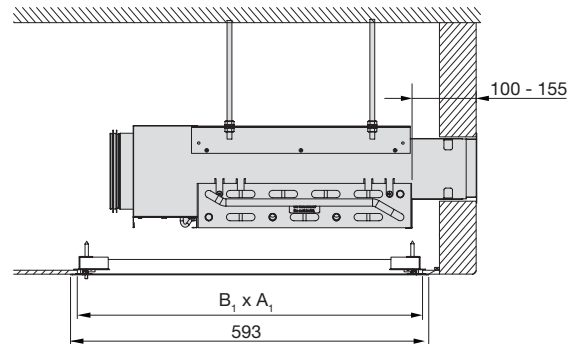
Montagezeichnung für Frontplatte -3S mit Ausschnittmaßen.
